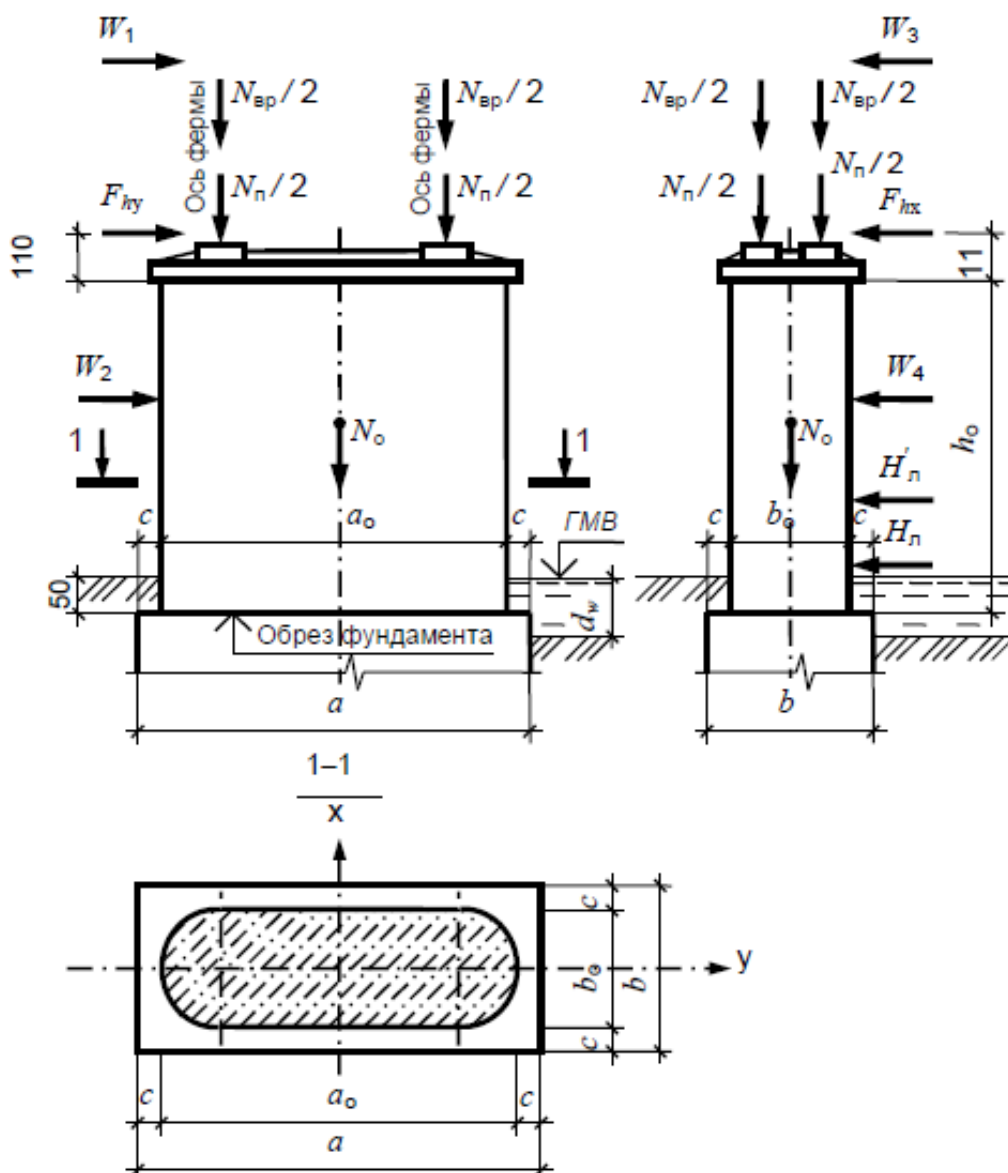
Конструкция надфундаментной части опоры
